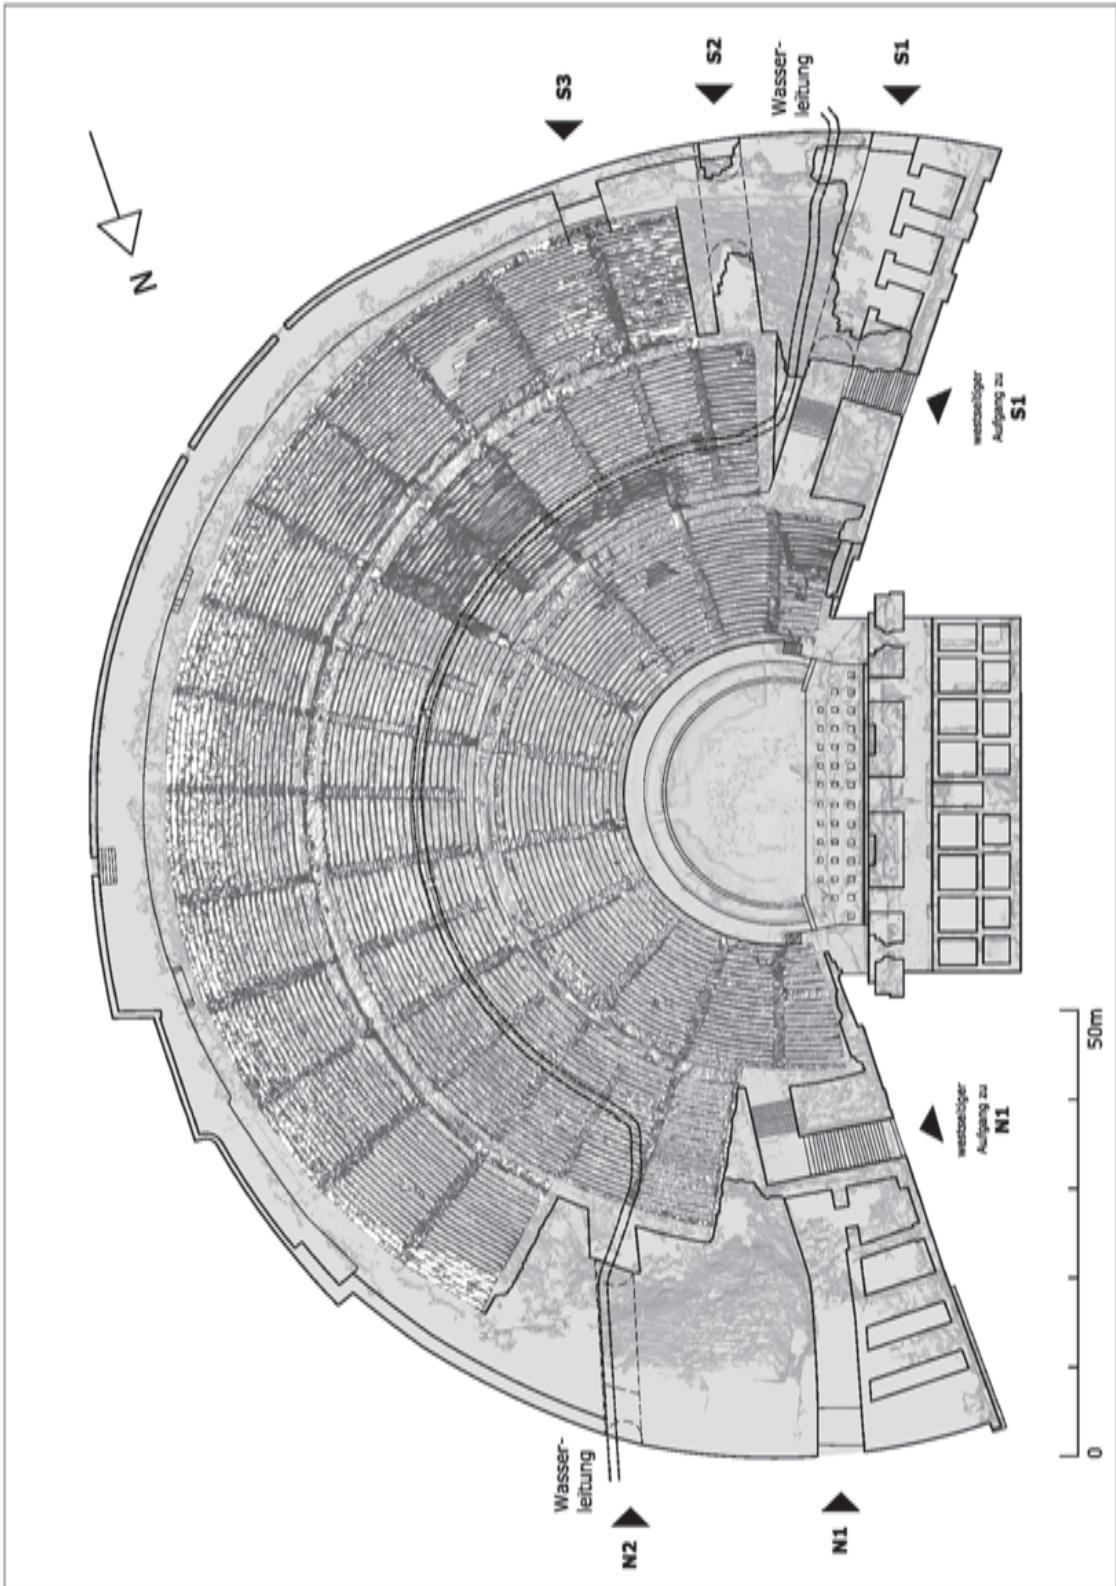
Grundriss-Schema der Theaterruine
